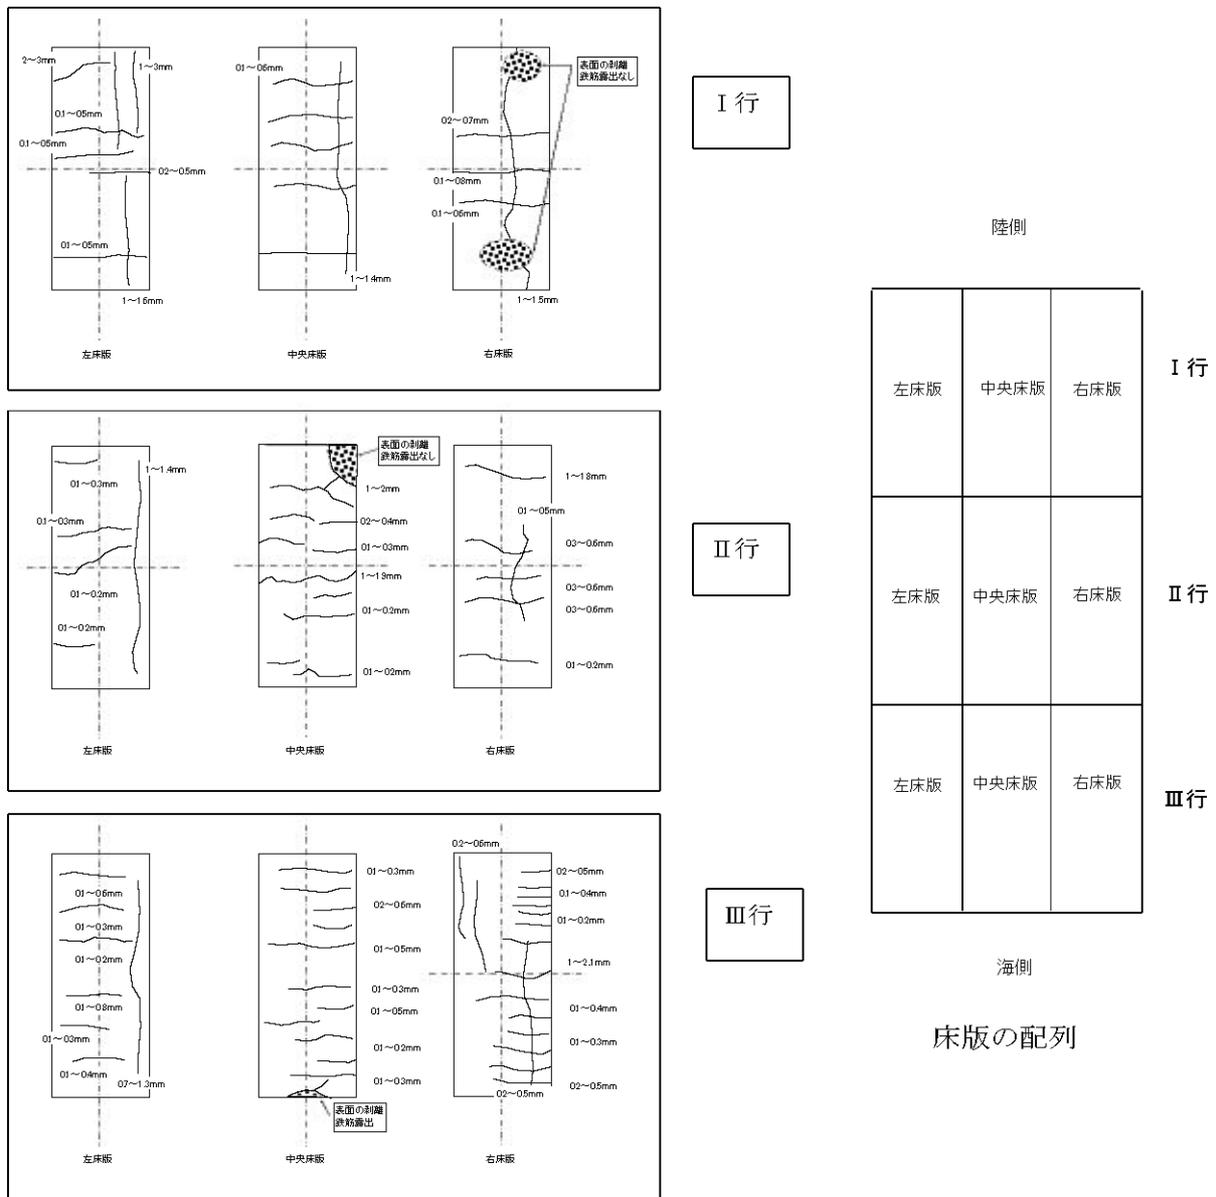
(2) 既設栈橋床版下部ひび割れ状況
